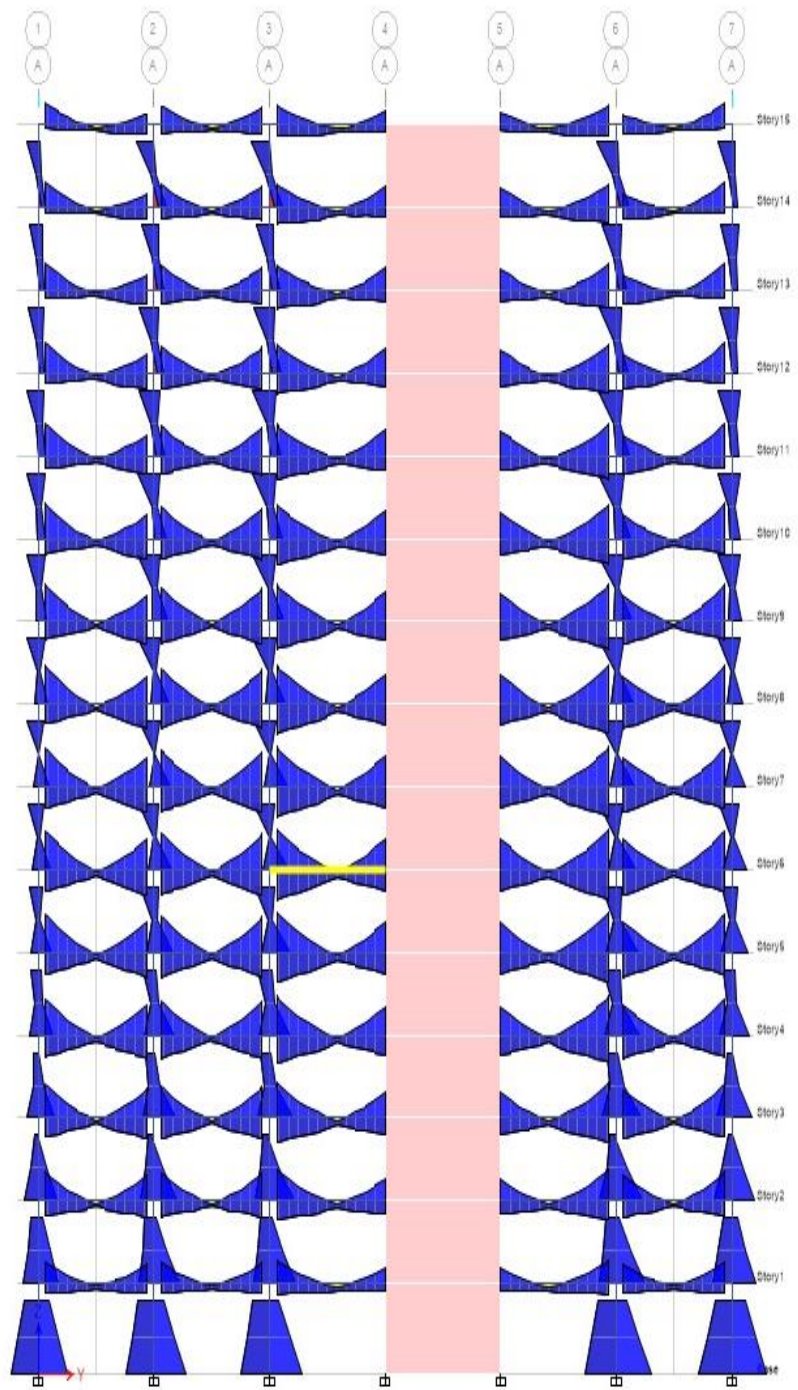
Elevación del pórtico donde se ubica la viga perimetral de V(0.30 X0.60) a diseñar
